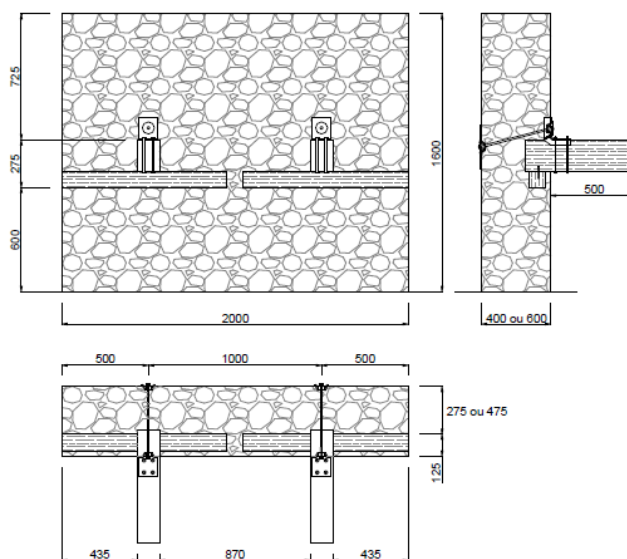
Posicionamento dos elementos de ensaio [25]
